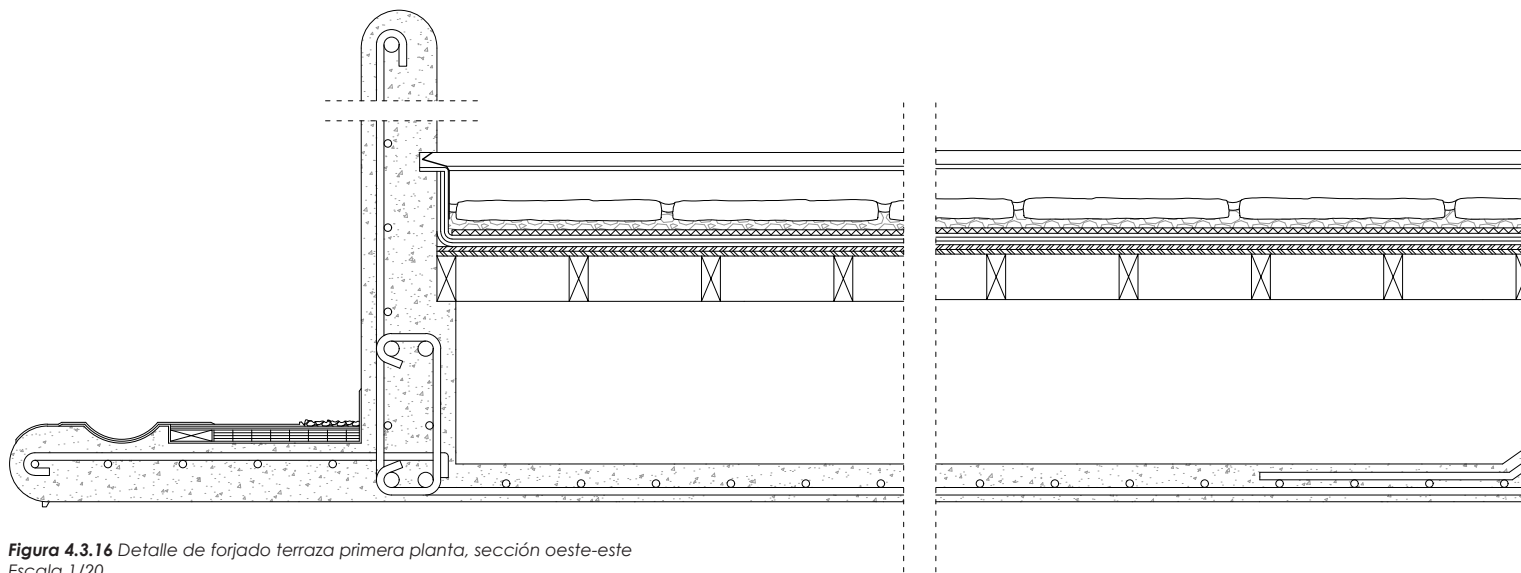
Detalle de forjado terraza primera planta, sección oeste-este
